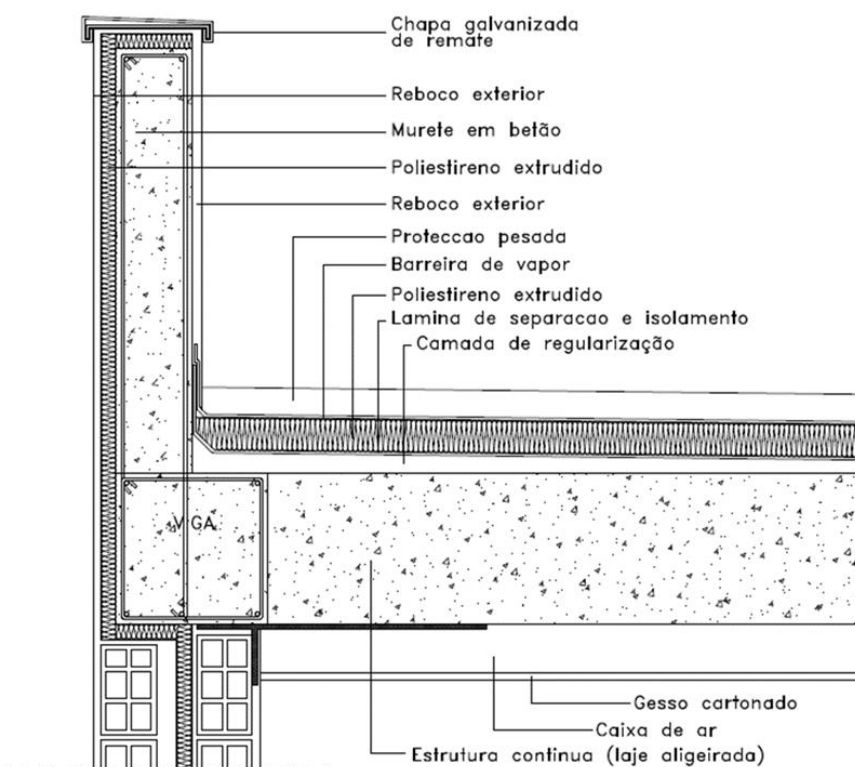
Pormenor construtivo tipo da cobertura da zona do jardim de infância
